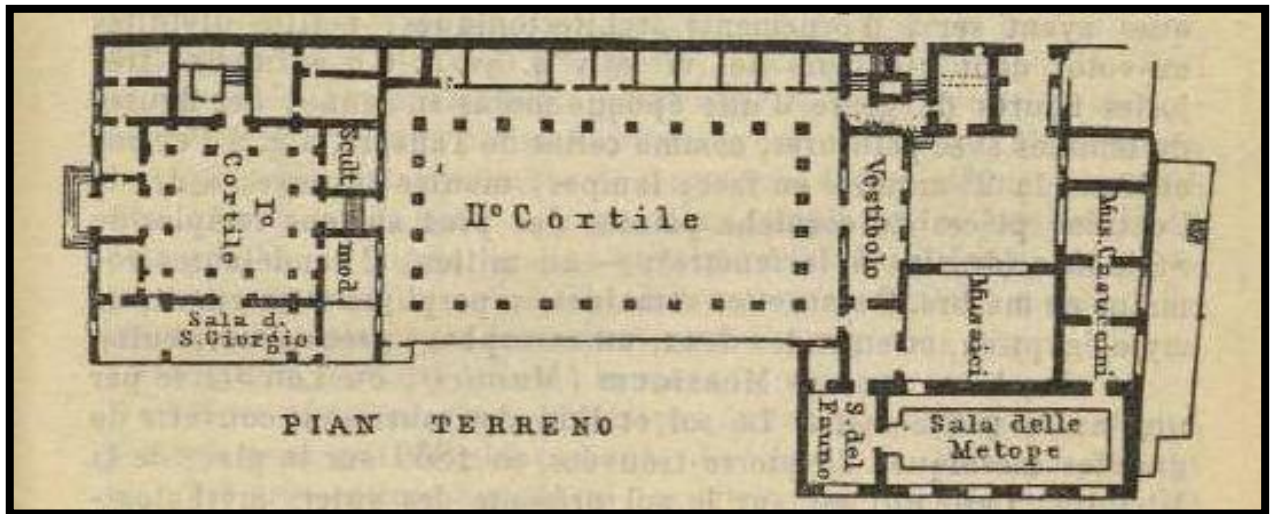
Karl Baedeker, *Plano de la planta baja del Palazzo Reale*, 1887, dibujo, BNE.
